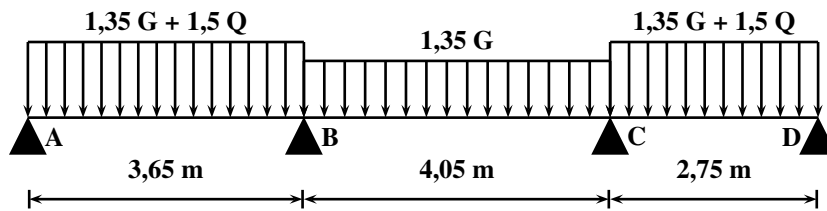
Poutrelle type 2 - cas 3 (ELU)
